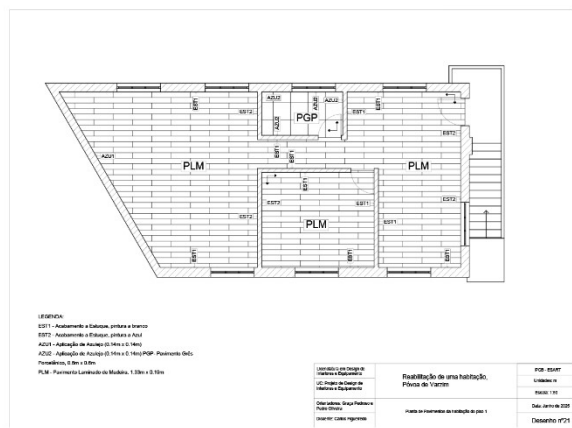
Planta de Pavimentos Habitação Piso 1. Fonte: Autor.
